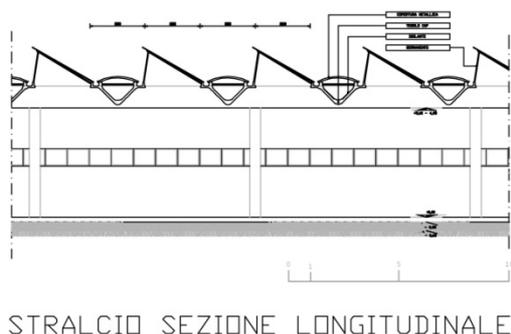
Stralcio della sezione longitudinale del capannone.
